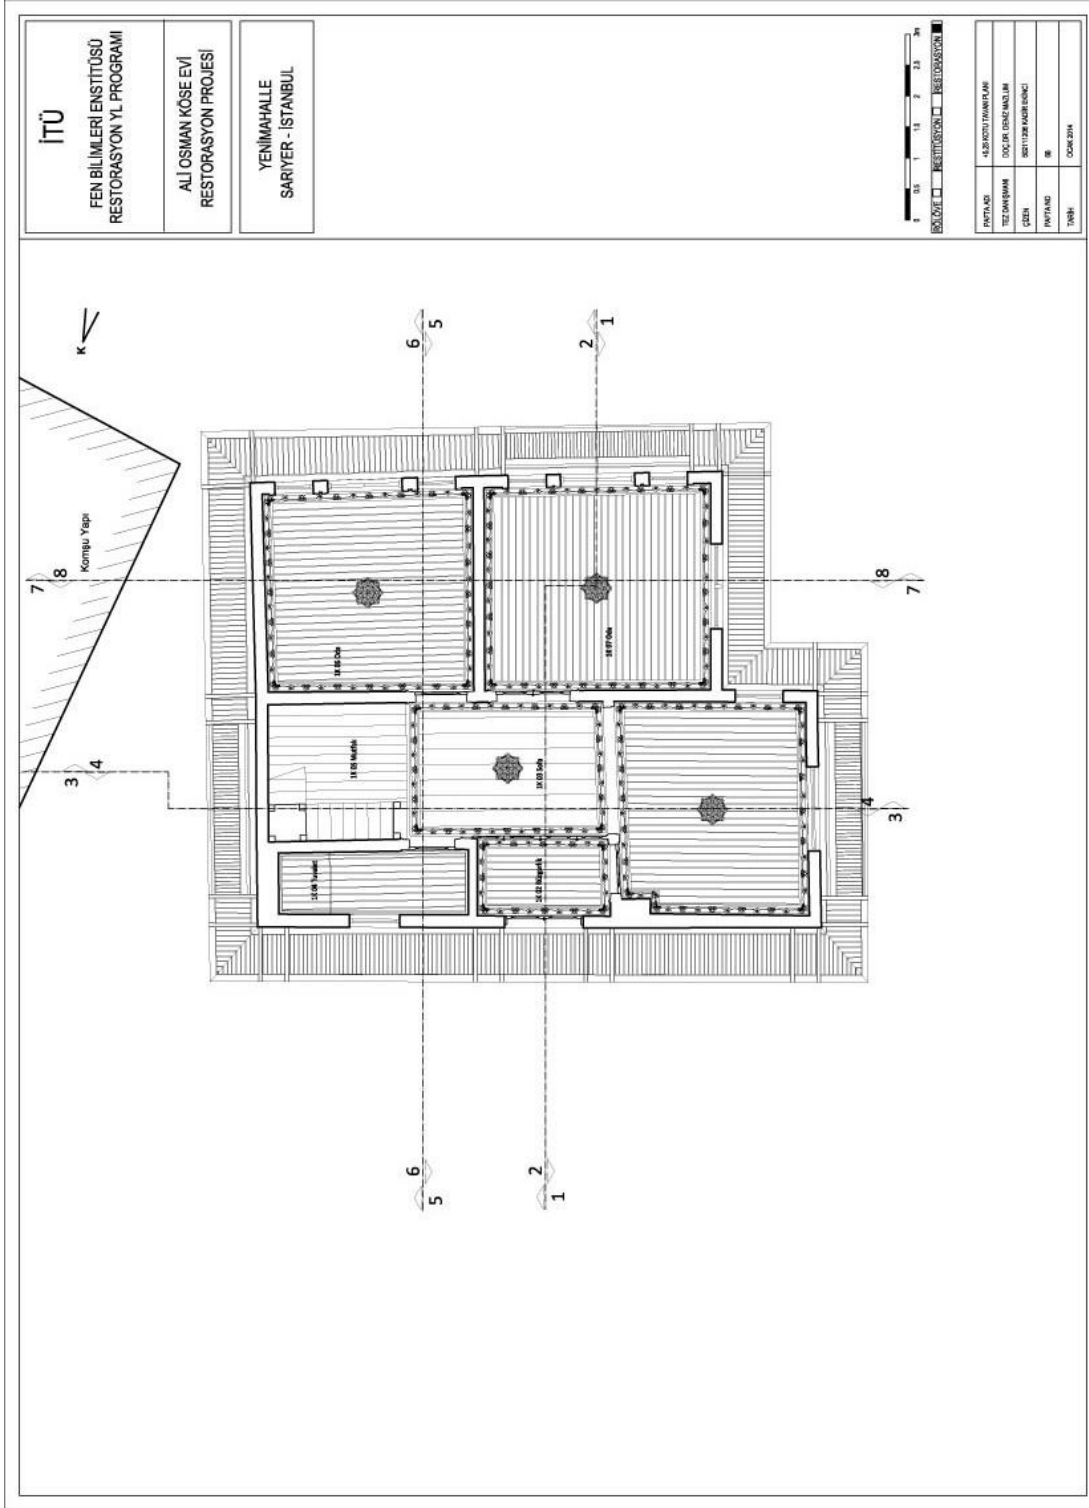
Restorasyon – -0.45 kotu tavan planı.
